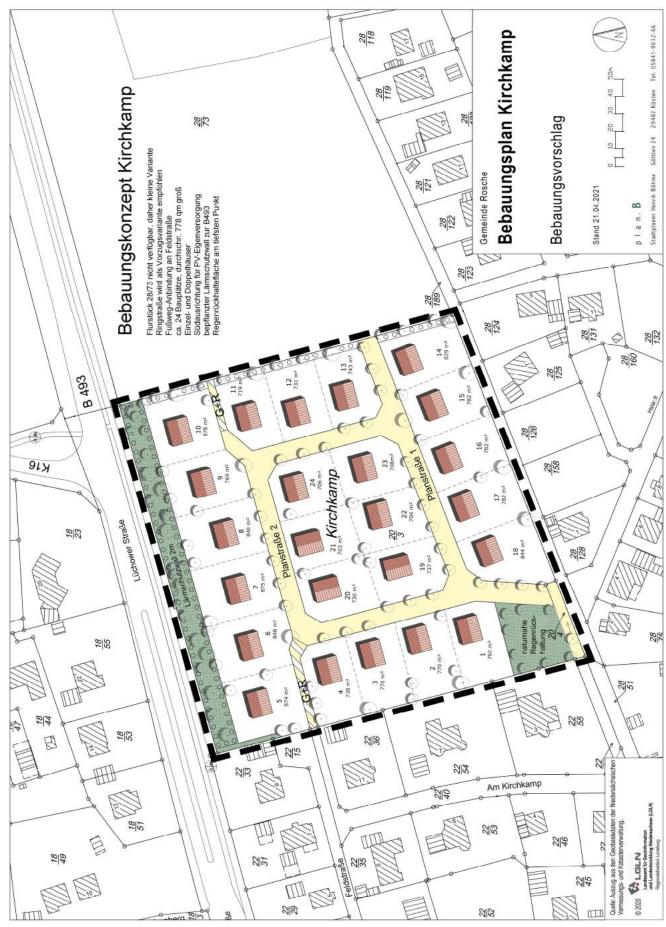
Bebauungsvorschlag, plan.B, April 2021
